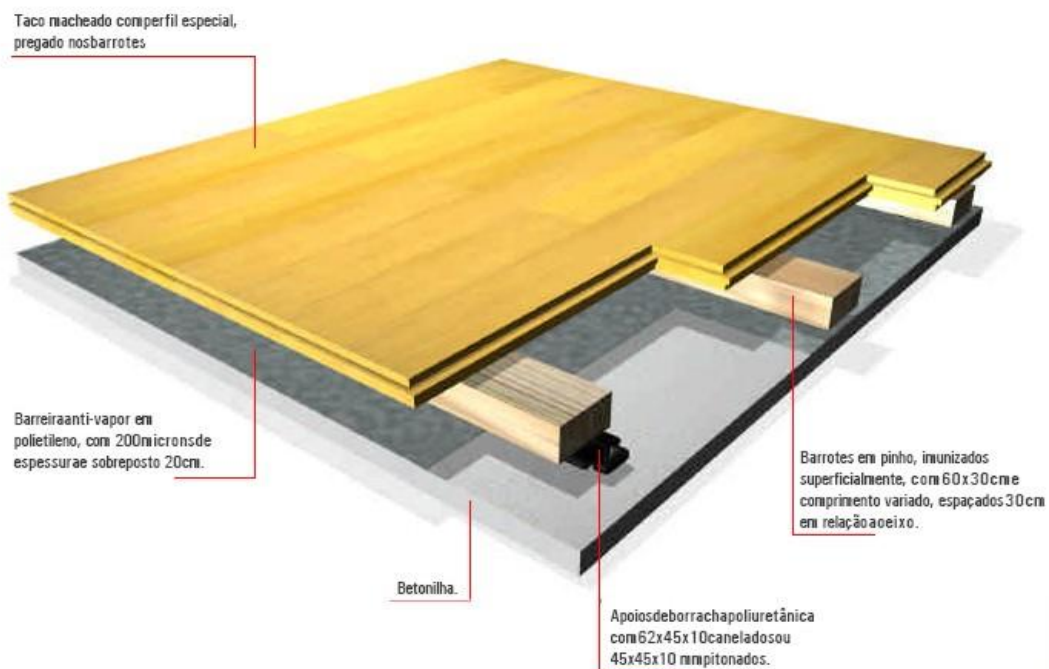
Figura H – Pavimento Desportivo em madeira flutuante e flexível com apoio em barrotamento simples
